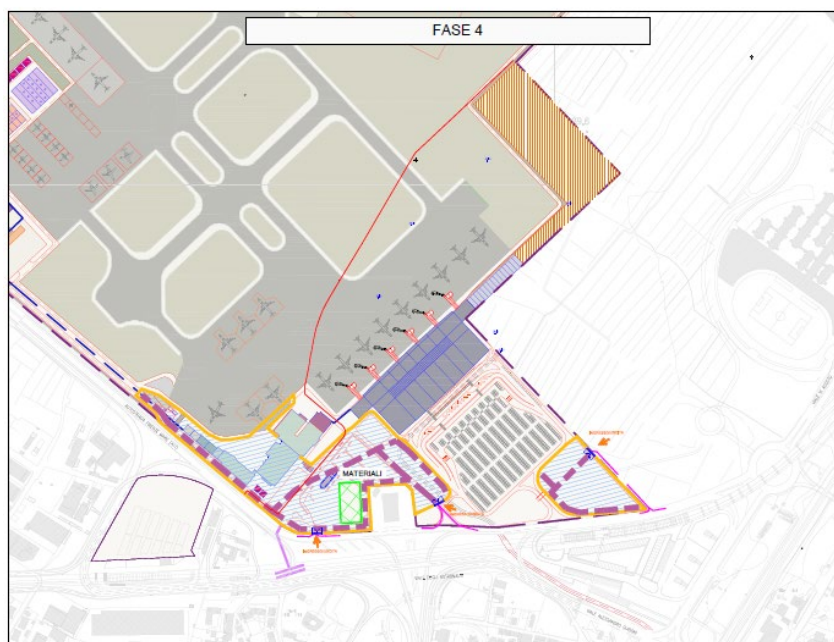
Cantierizzazione dell'area nuovo terminal passeggeri – Fase 4
